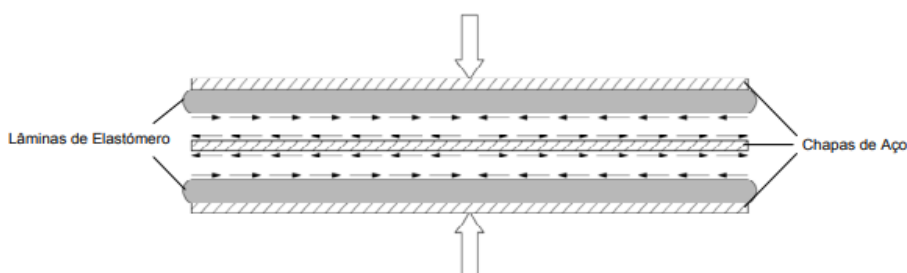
Interação entre as placas de aço e as lâminas de elastômero para carregamentos verticais.
